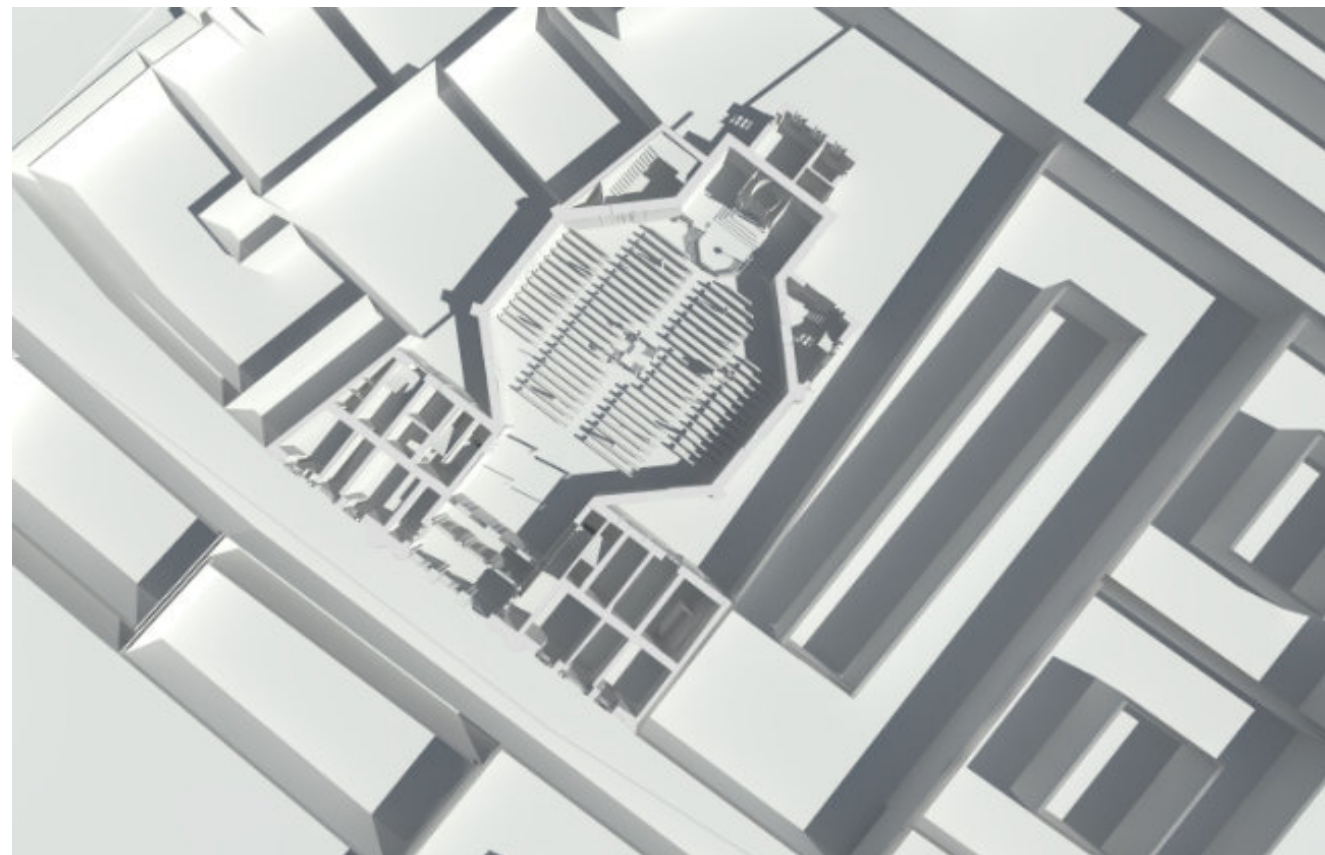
28.: 3D Grundriss - Erdgeschoß, Weißrendering.
